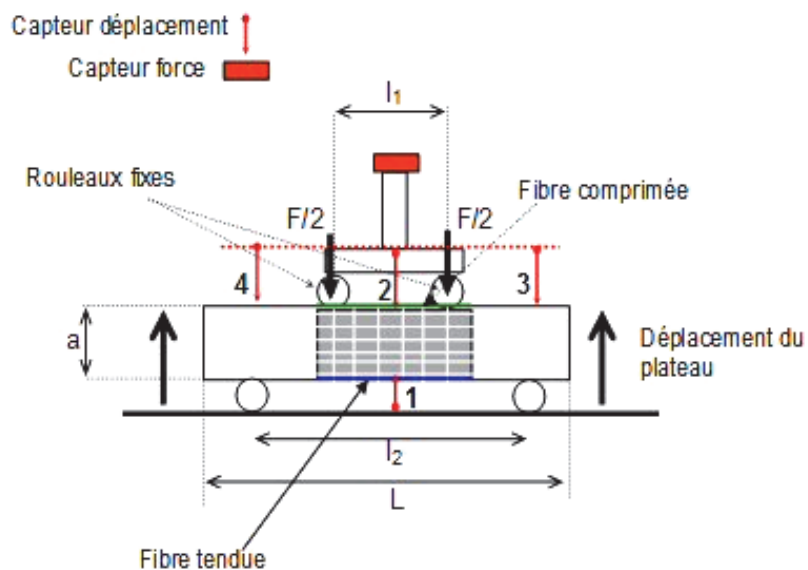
Schéma de la poutre de l'essai de flexion 4 points (Camp et al., 2010)
